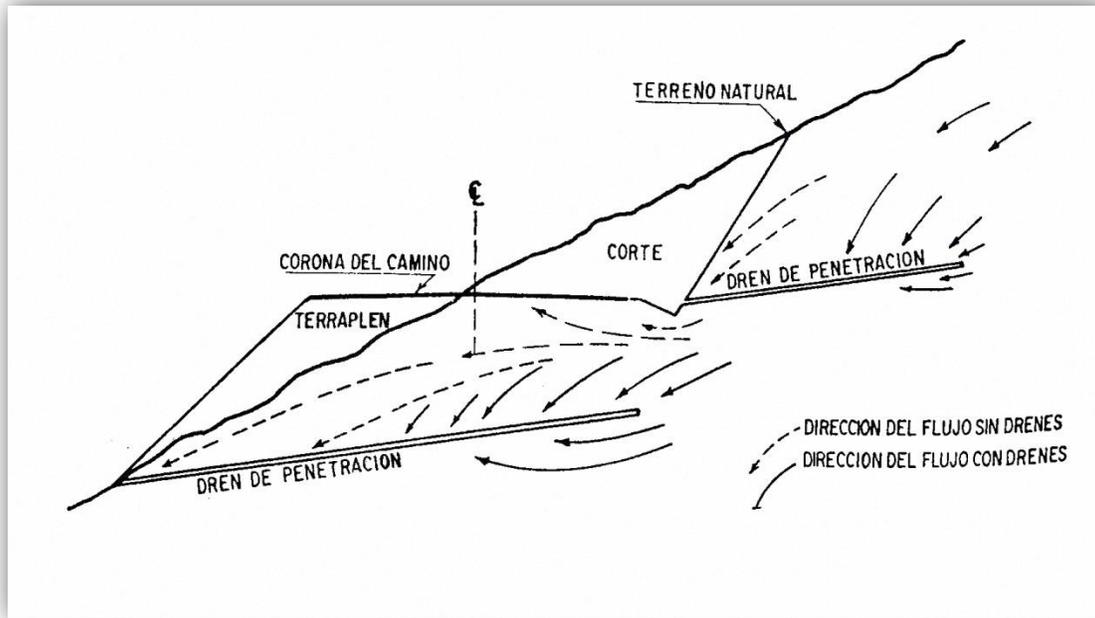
Esquema de la influencia de los drenes transversales de penetración en una sección en balcón (ref. 18).
